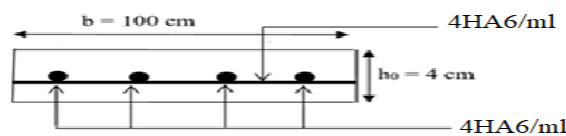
Schéma de ferraillage de la dalle de compression
